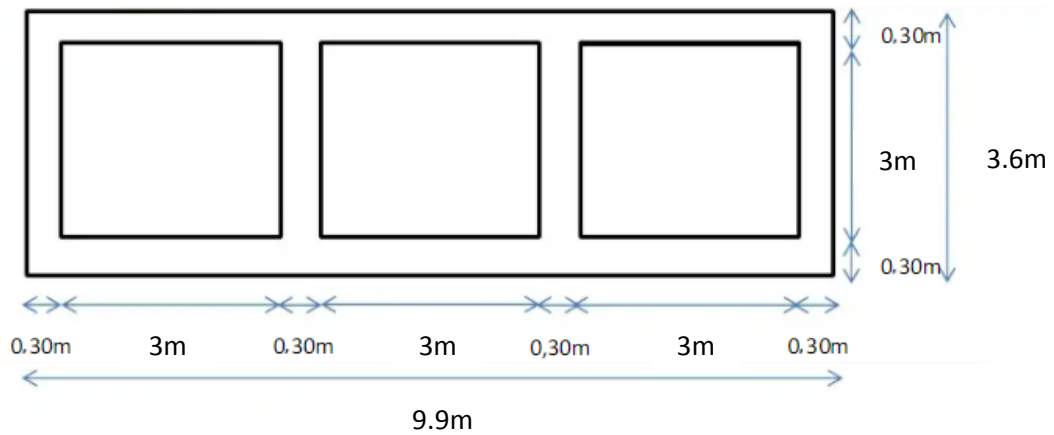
profile en travers des dalots de la route de Bouchaoui tronçon B5
